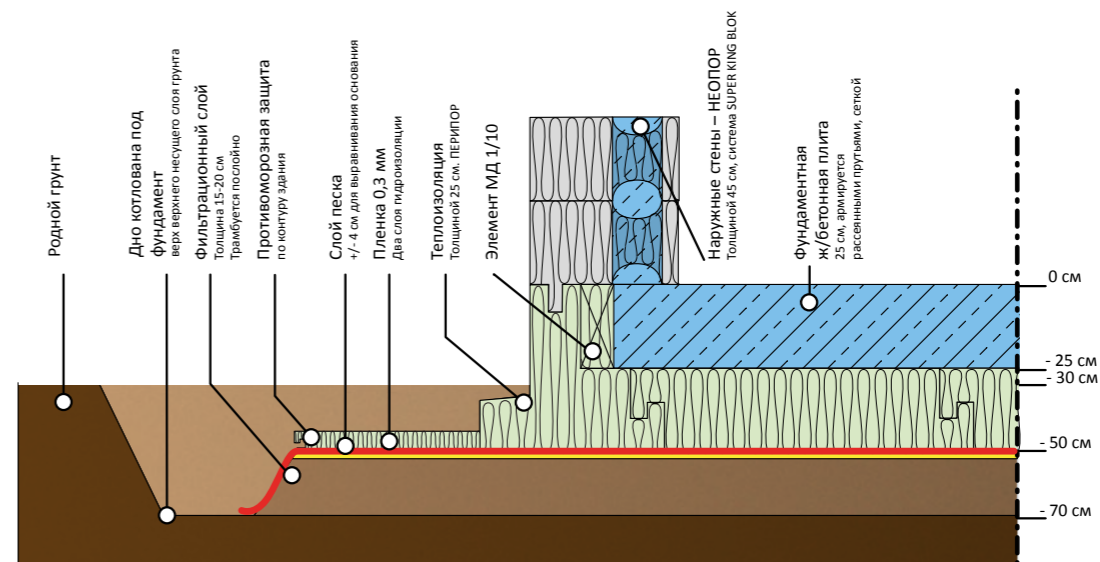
Схема устройства фундаментной плиты в версии с наружными стенами шириной 45 см SUPER KING BLOK
